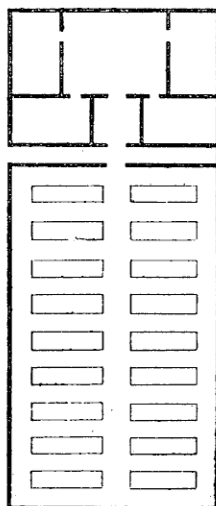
Fragment du plan de l'abbaye de Saint-Gall.
